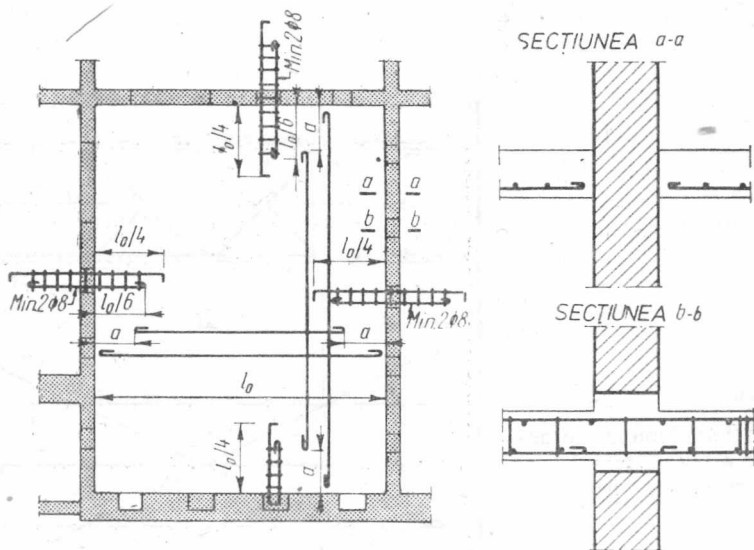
Armarea planșelor din beton armat monolit la structurile cu diafragme executate cu cofraje glisante.
